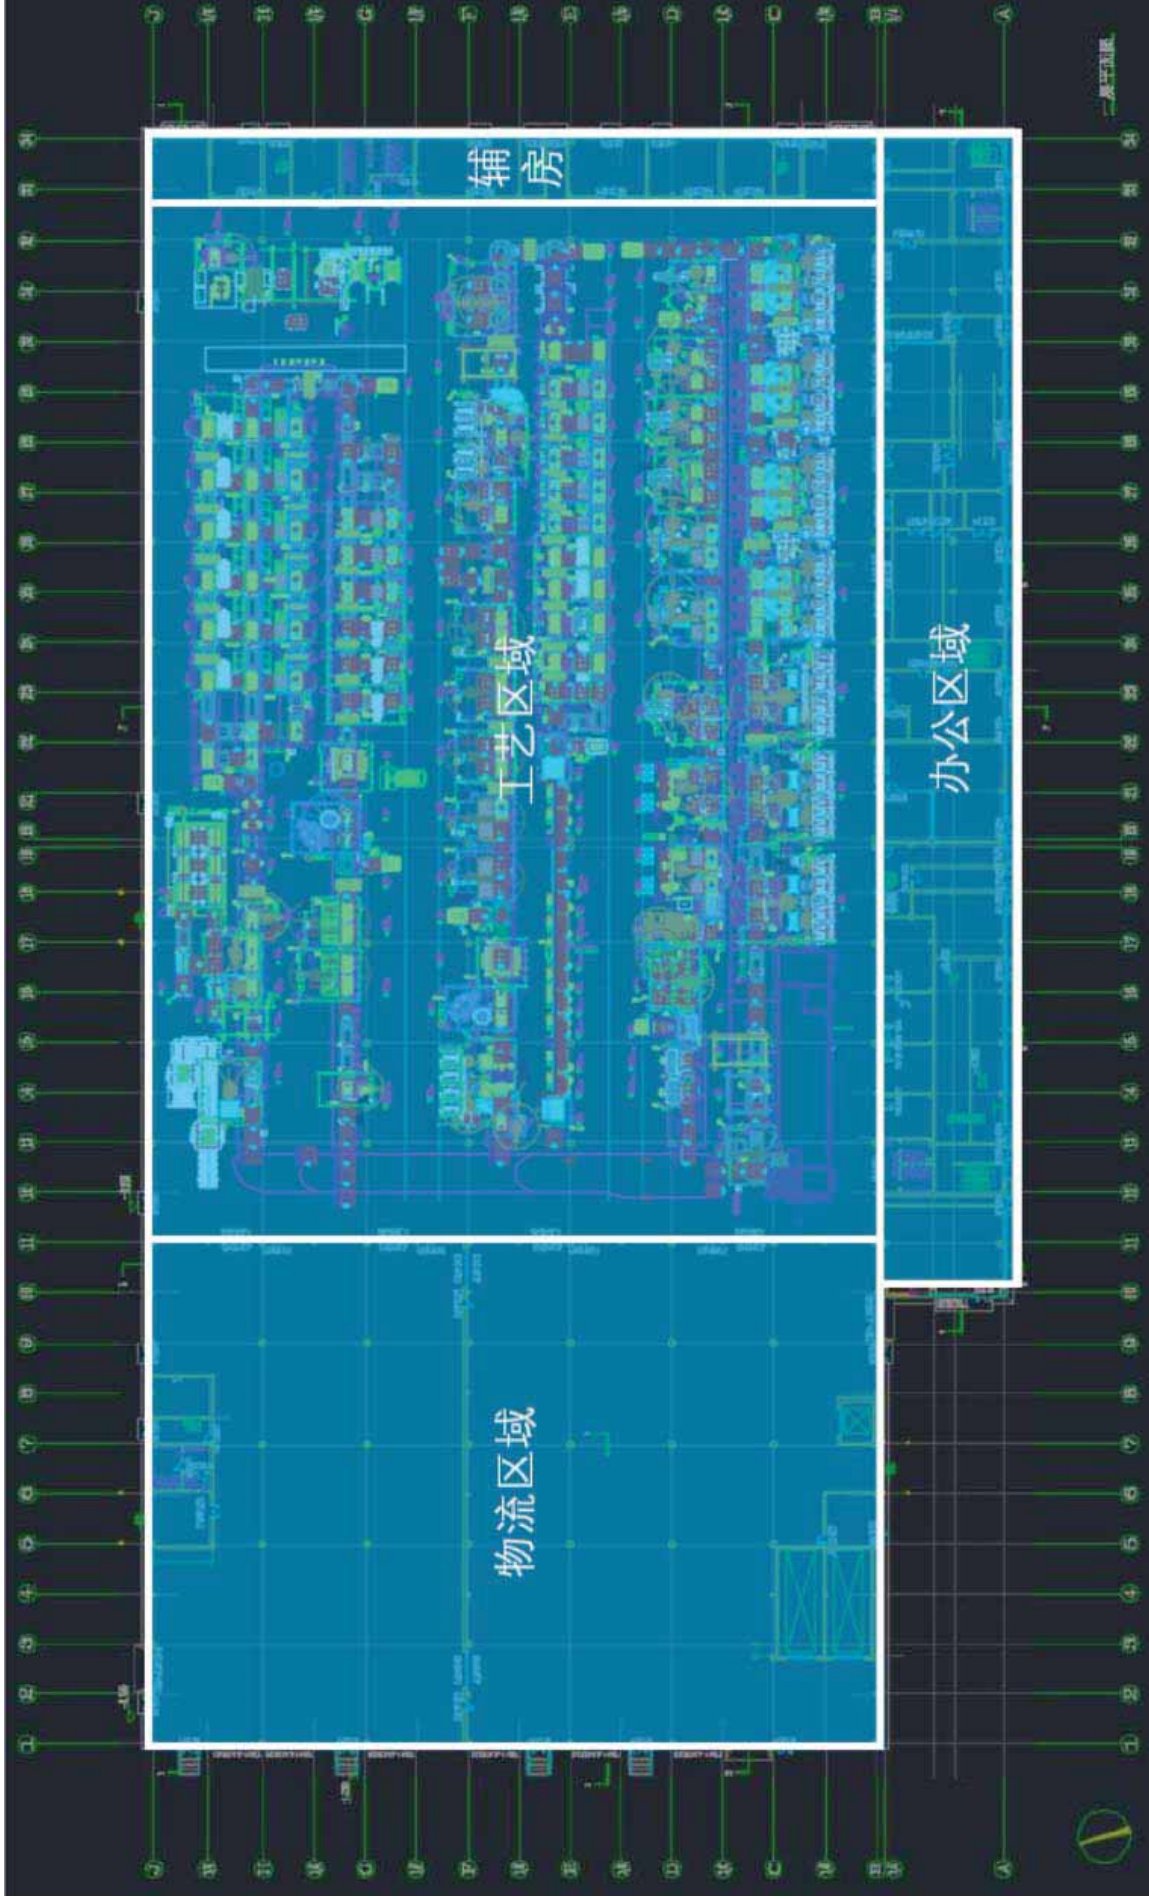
车间一楼 (电池组装 PACK 装配生产线) 平面布置示意
